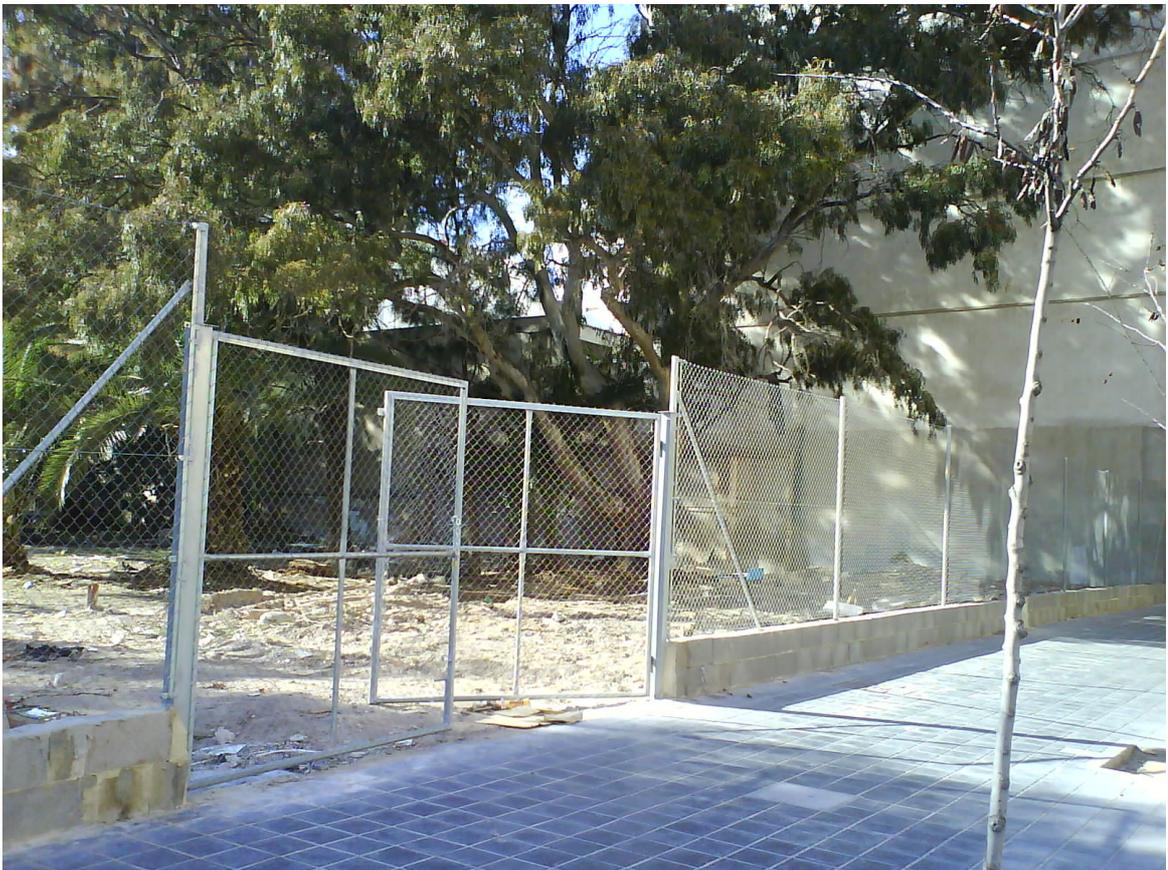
Foto de los terrenos desde la Avda de la Malvarrosa
